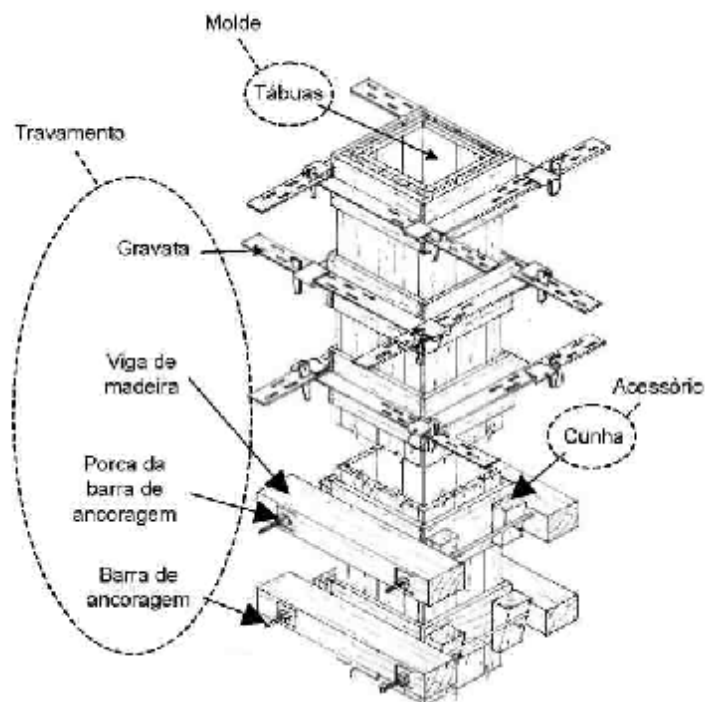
Esquema genérico de fôrma para pilar com molde em tábuas e travamento constituído por gravatas metálicas e vigas de travamento em madeira com barra de ancoragem.
